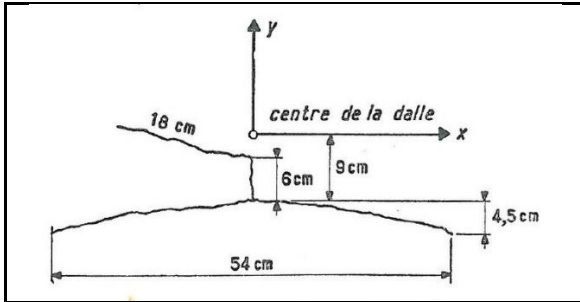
Fissures de la dalle I en fin de phase de « première fissuration »
